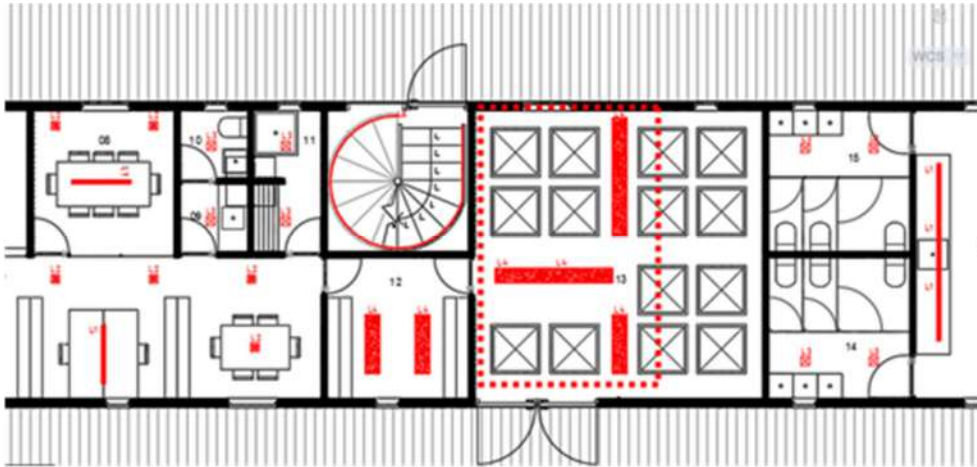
LAYOUT PARA LUMINARIAS EN BODEGAS Y PAÑOL
